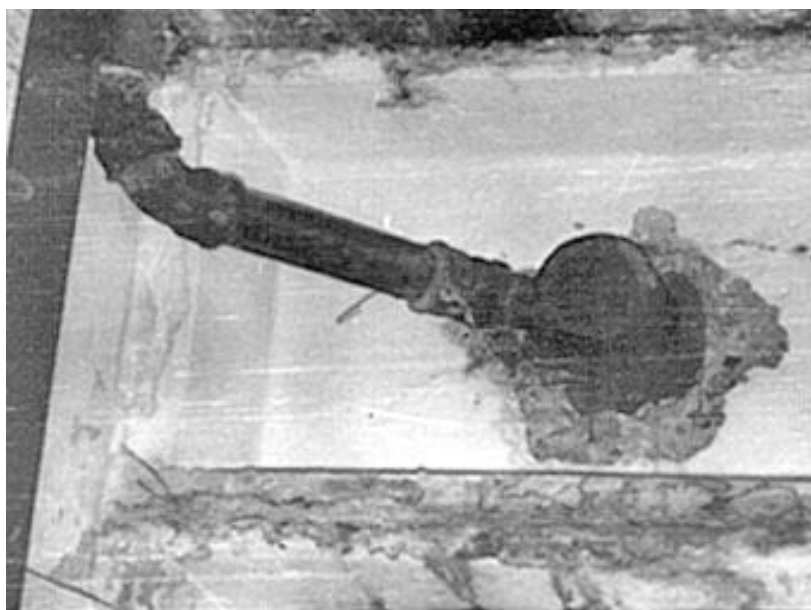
Коррозия железобетонной плиты перекрытия в месте пропуска труб подачи глицерина (фото автора)
